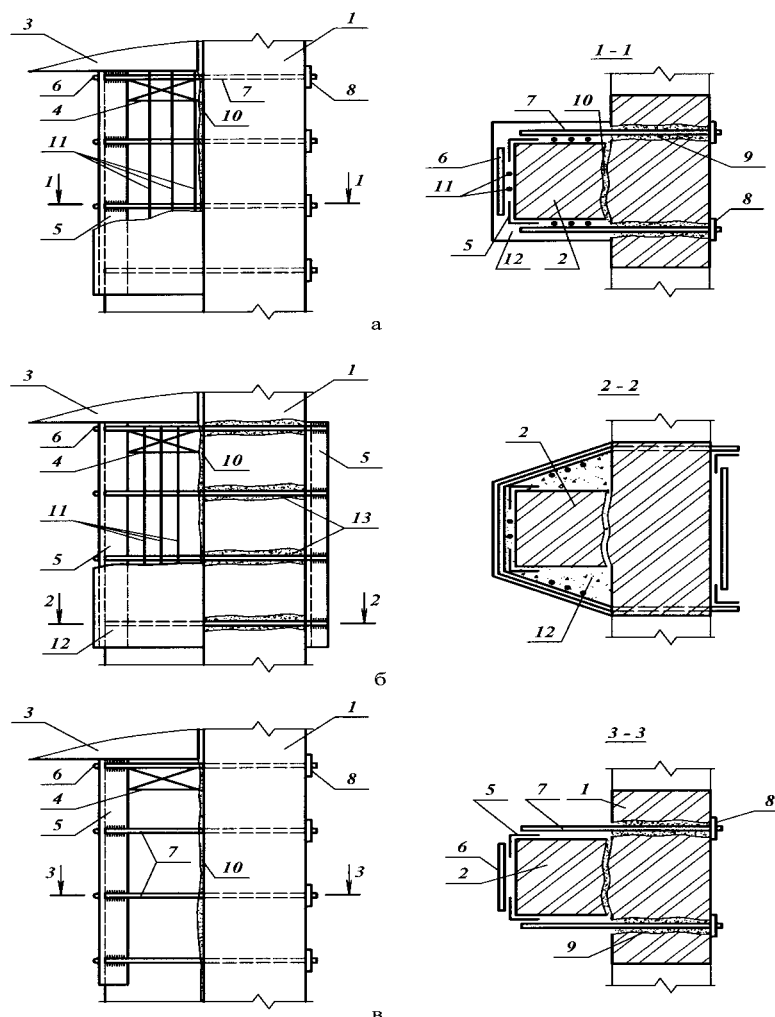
Усиление узлов опирания балок на элементы каменных конструкций устройством обойм:
